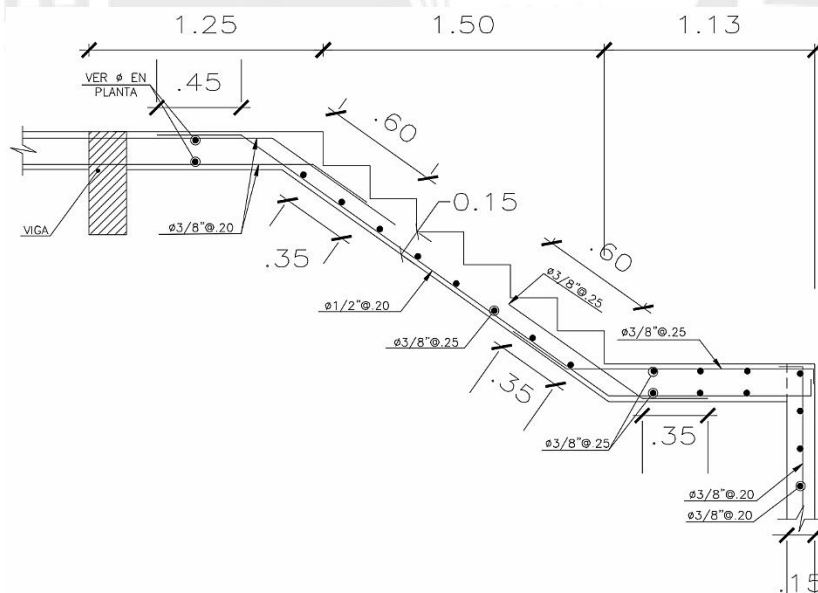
Detalle de armado del segundo segmento de escalera en piso típico
